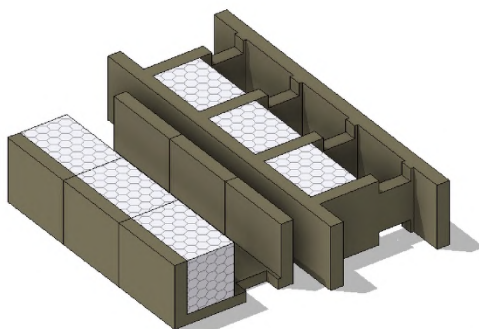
Блоки опалубки рядовые из керамзитобетона
